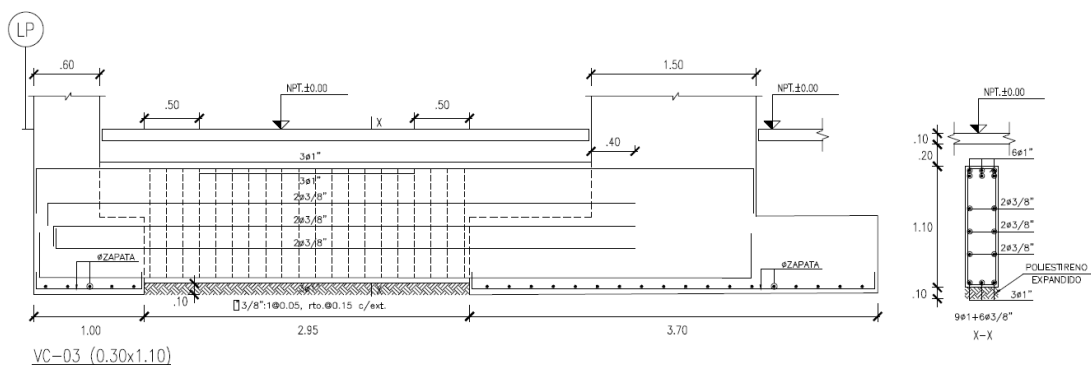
Vista en elevación de la viga de cimentación VC-03.
